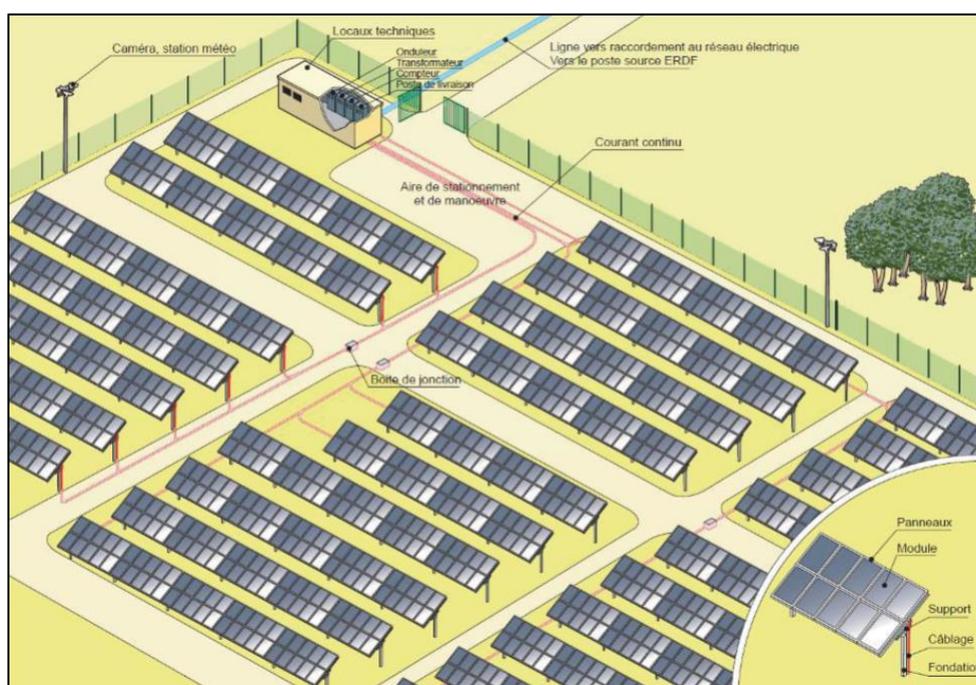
Schéma de principe d'une installation photovoltaïque
